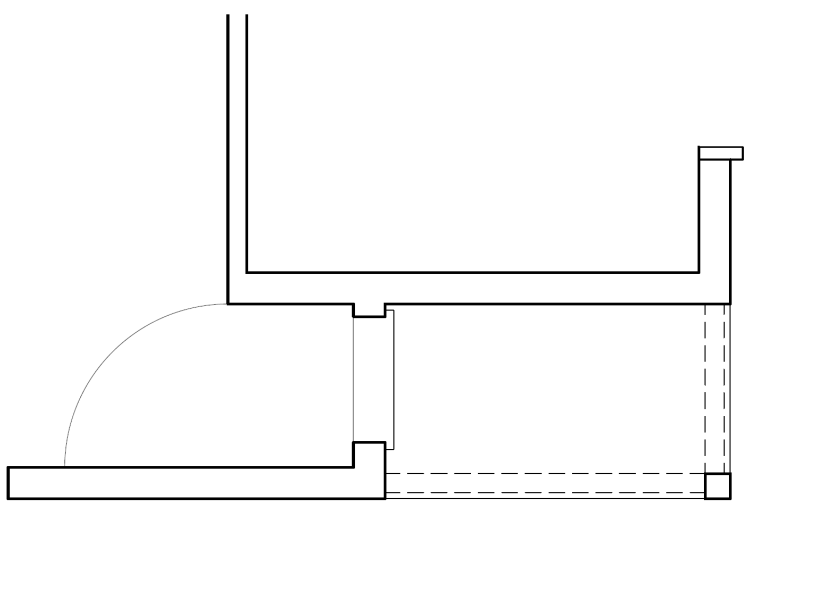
Etapas de representação da planta baixa: desníveis, transições de piso e elementos em projeção. Fonte: autor
